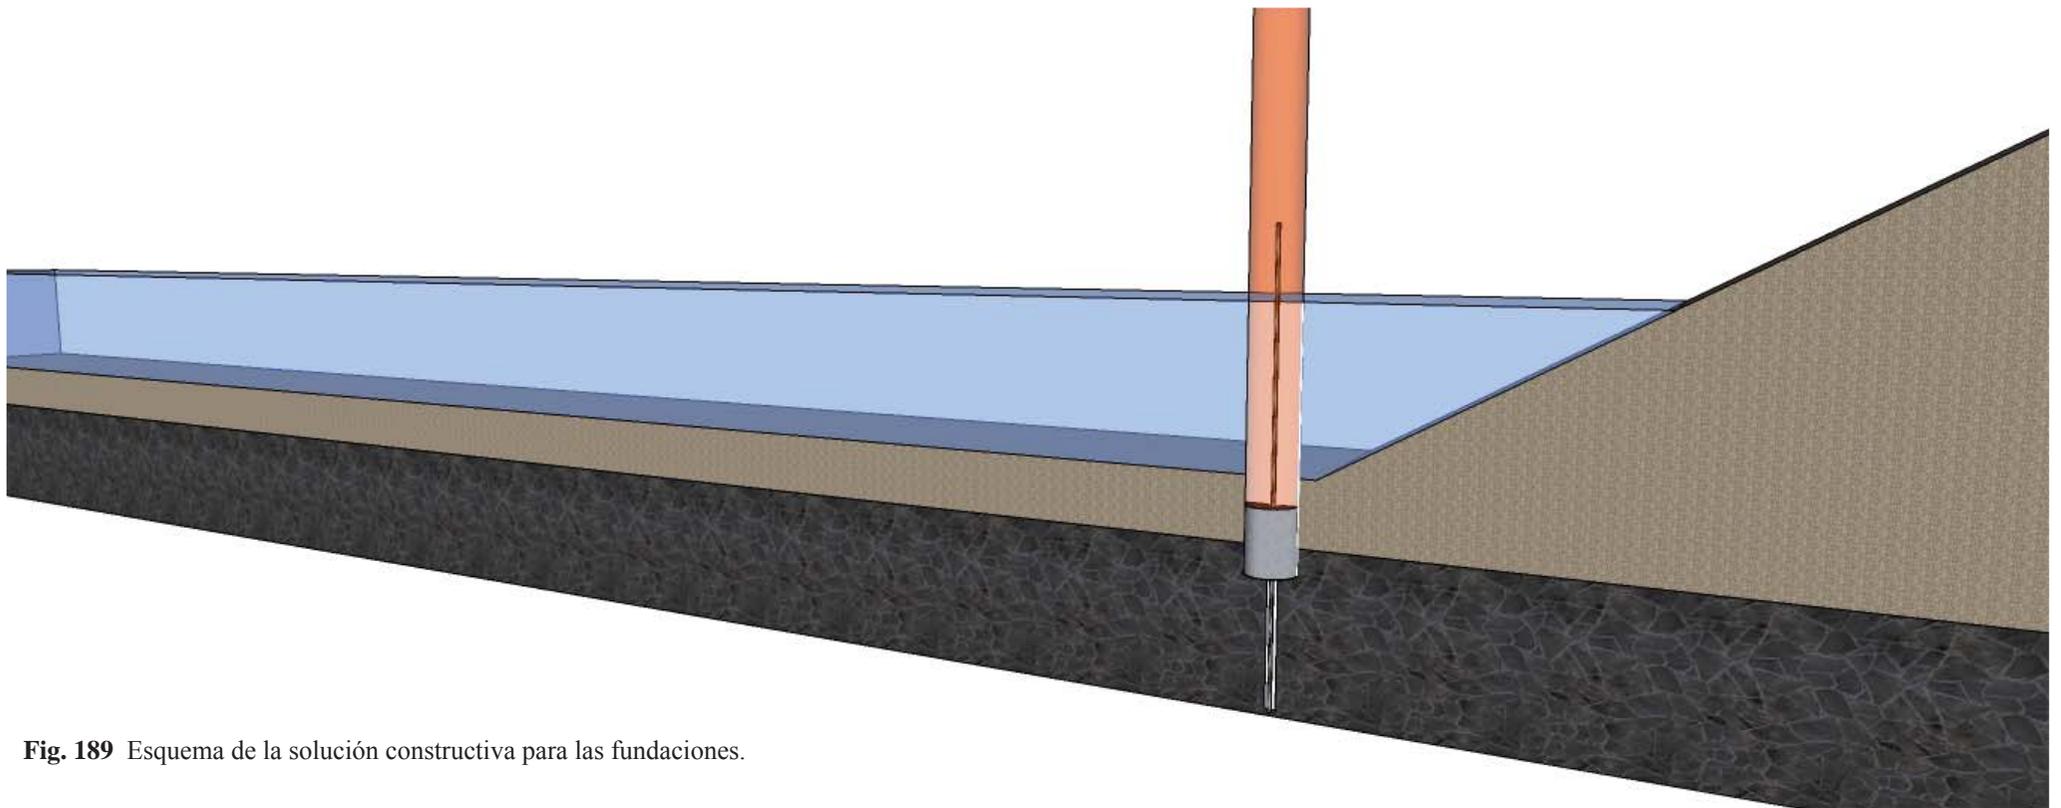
Esquema de la solución constructiva para las fundaciones.
